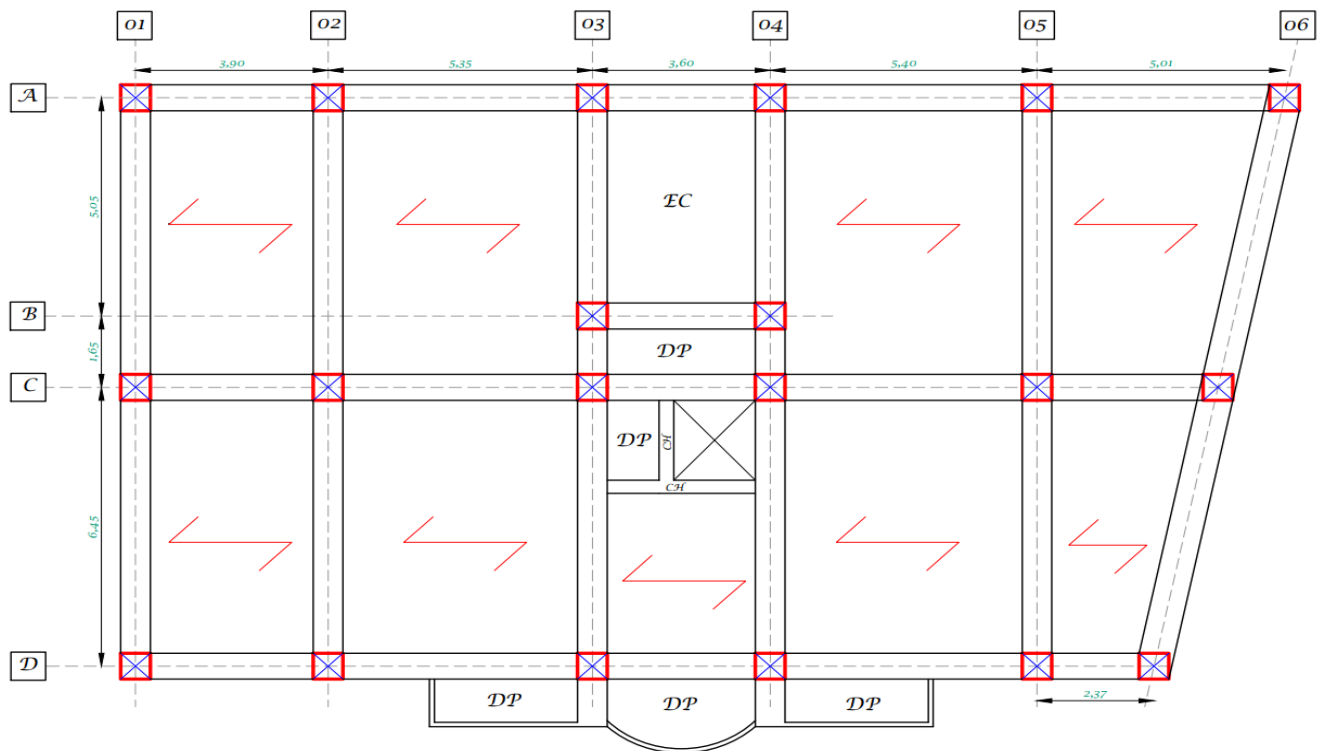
Plan de disposition des poutrelles étages 02 jusqu'à étage 10.
